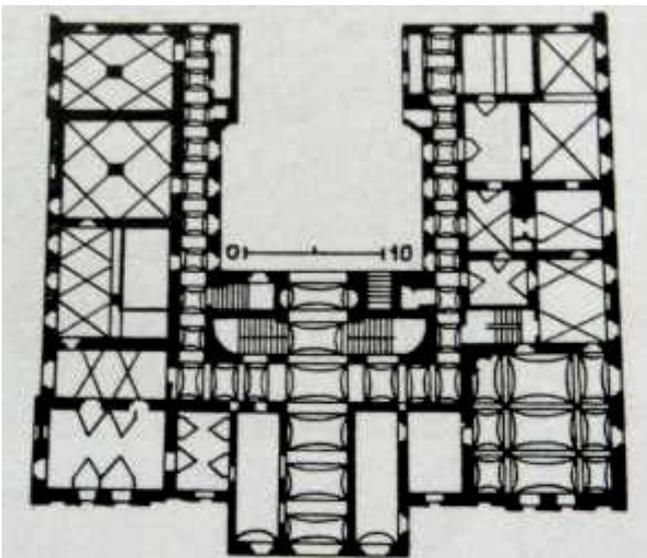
Schloss Ráday in Pécel, Grundriss
